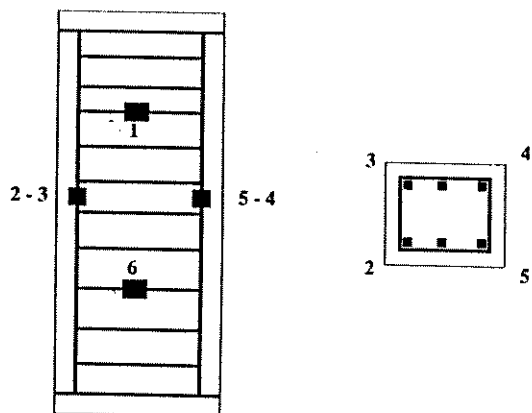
DEFORMAÇÕES NO CONCRETO E NAS ARMADURAS
